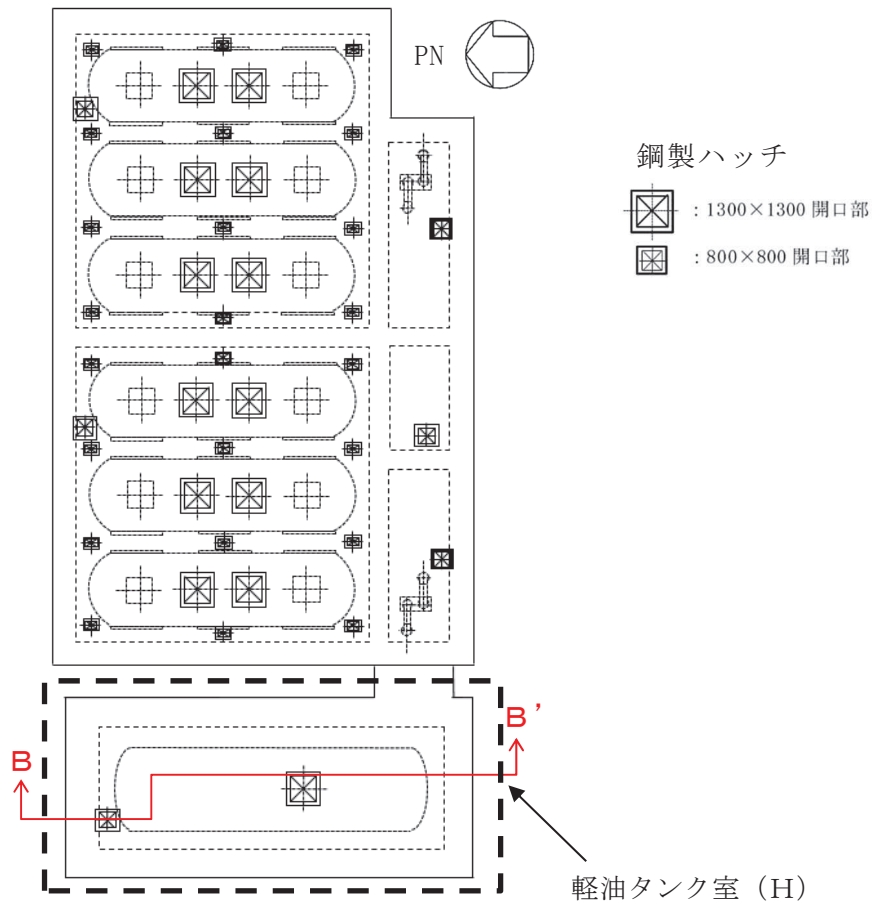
軽油タンク室 (H) の概略平面図 (O.P. 14.80m)
